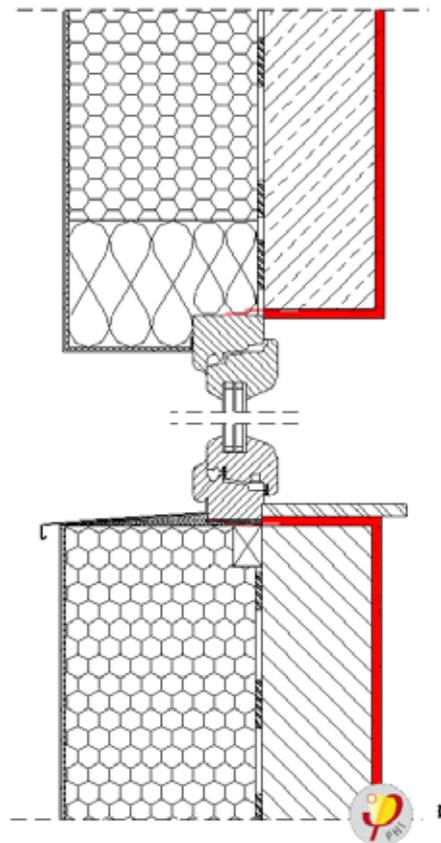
Optimierte Einbausituation: Fenster mit Einbaukonsole aus Holz oder Polyurethan-Recyclingmaterial in Massivbauwand mit Wärmedämm-Verbundsystem. Das Fenster wird vor dem Mauerwerk angeordnet und damit ausreichend weit in die Dämmebene gerückt. In Laibung und Sturz kann der Rahmen überdämmt werden.
